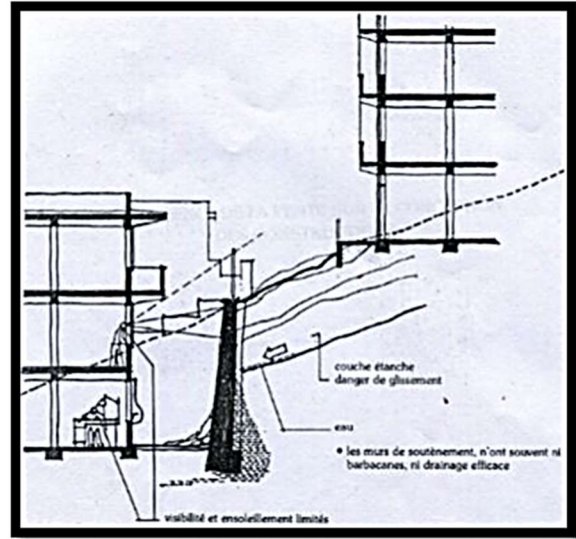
La stabilité des constructions n'est pas toujours assurée.
